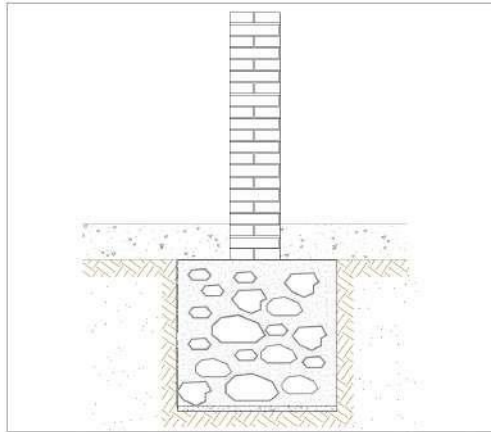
Cimentación corrida bajo pilar. Fuente propia
